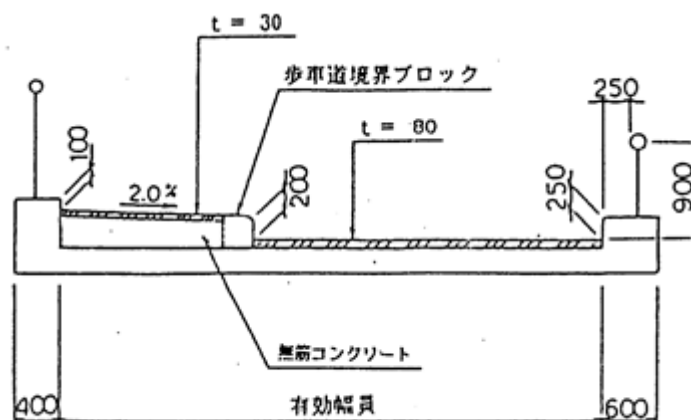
マウンドアップ形式歩道 (単位:mm)
